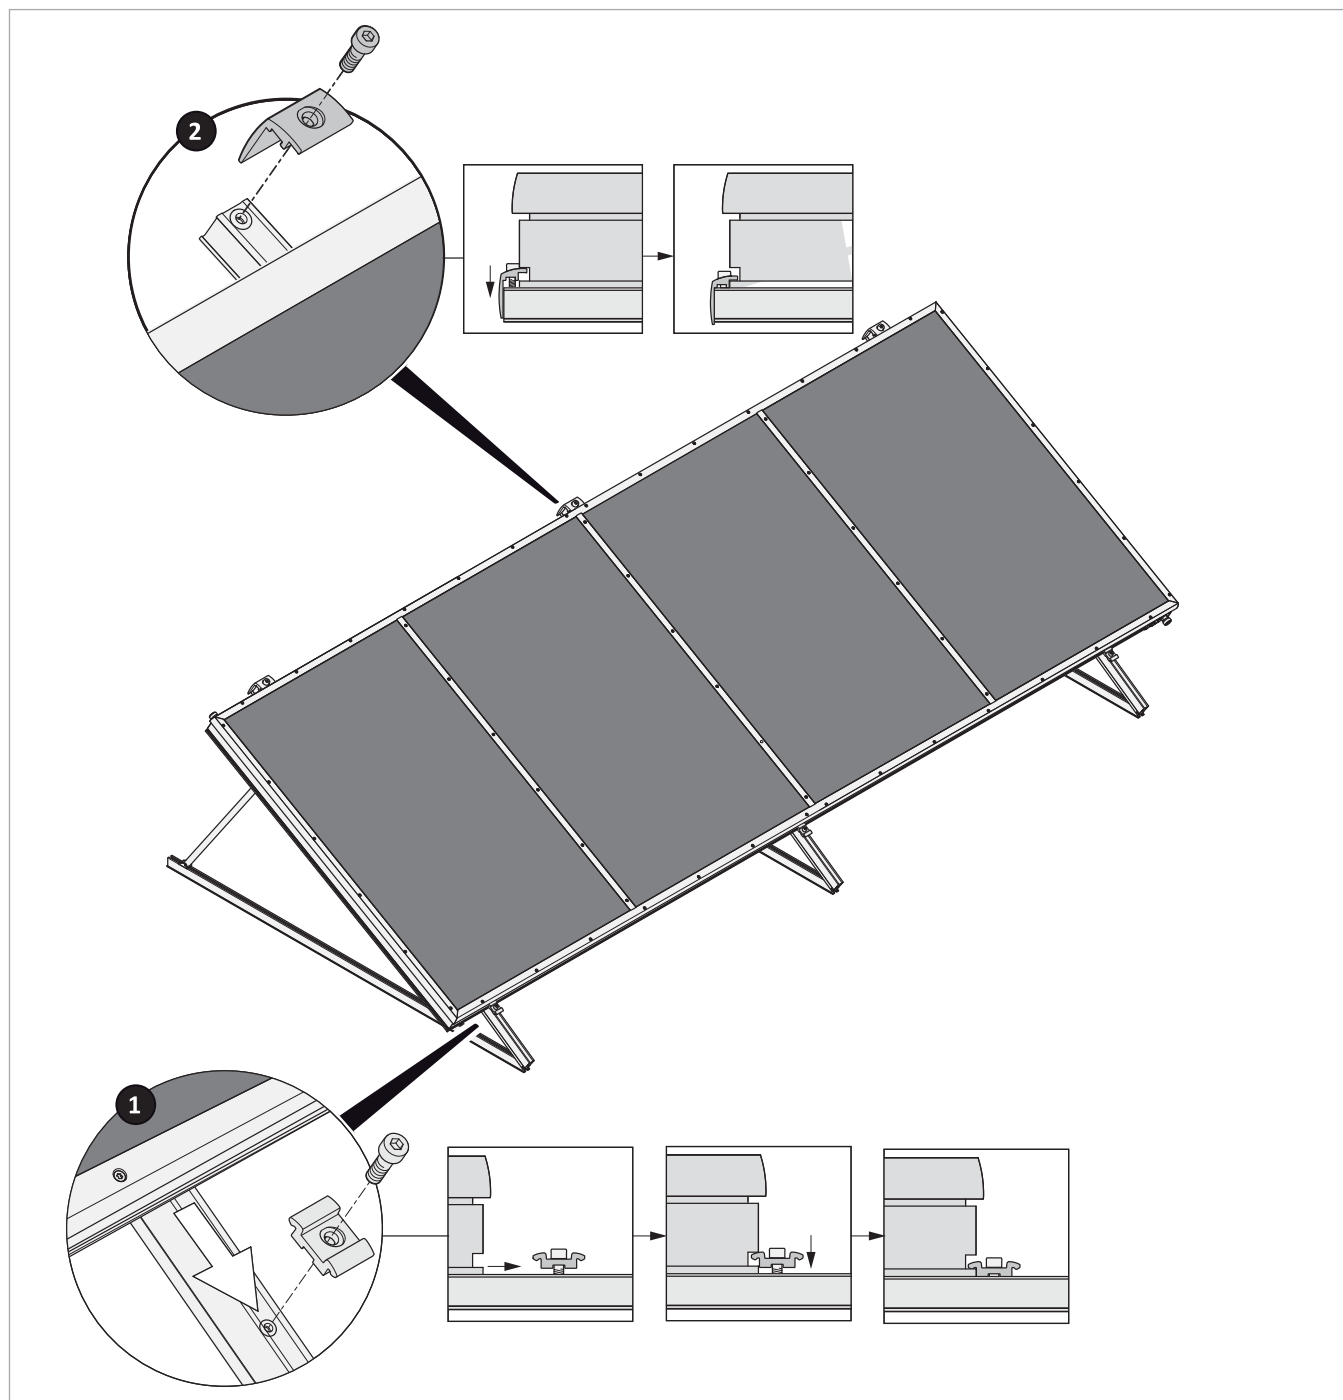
fixation d'un capteur sur les montants pour toit plat
